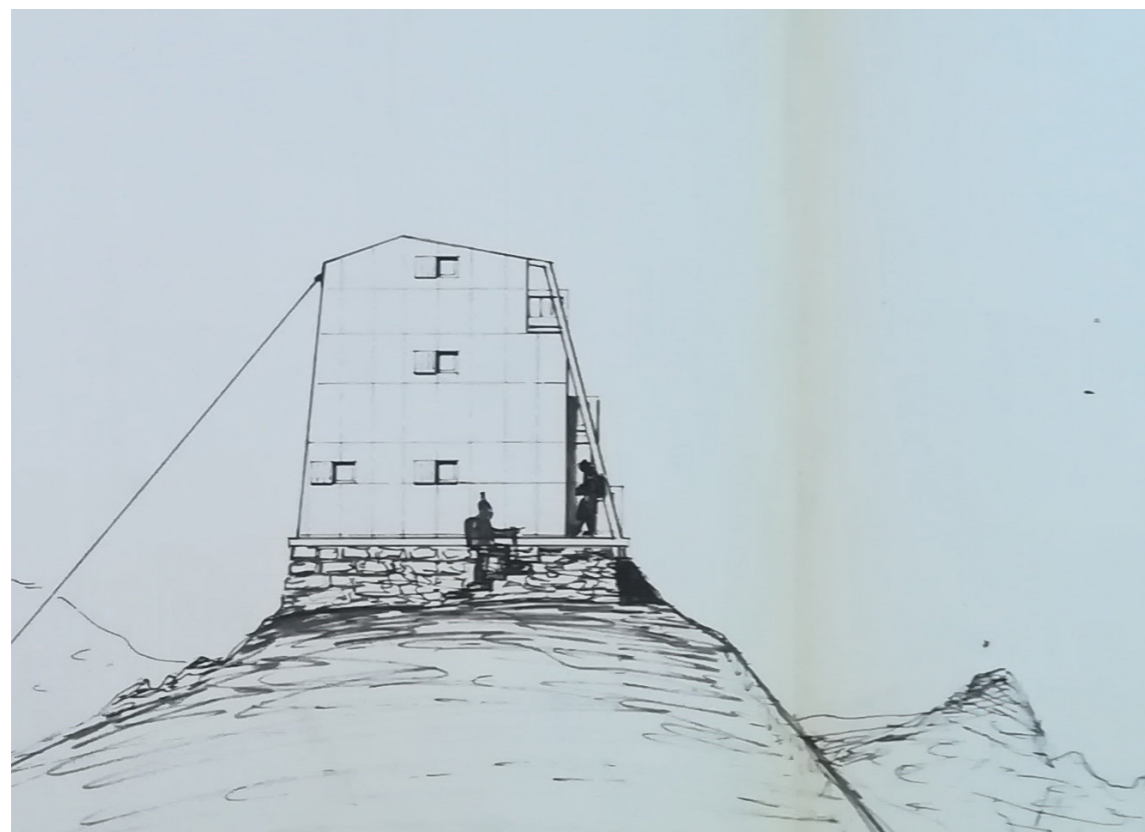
Prospetto sud-ovest progetto originale del 1977 redatto dallo studio del geometra Carlo Milone.
